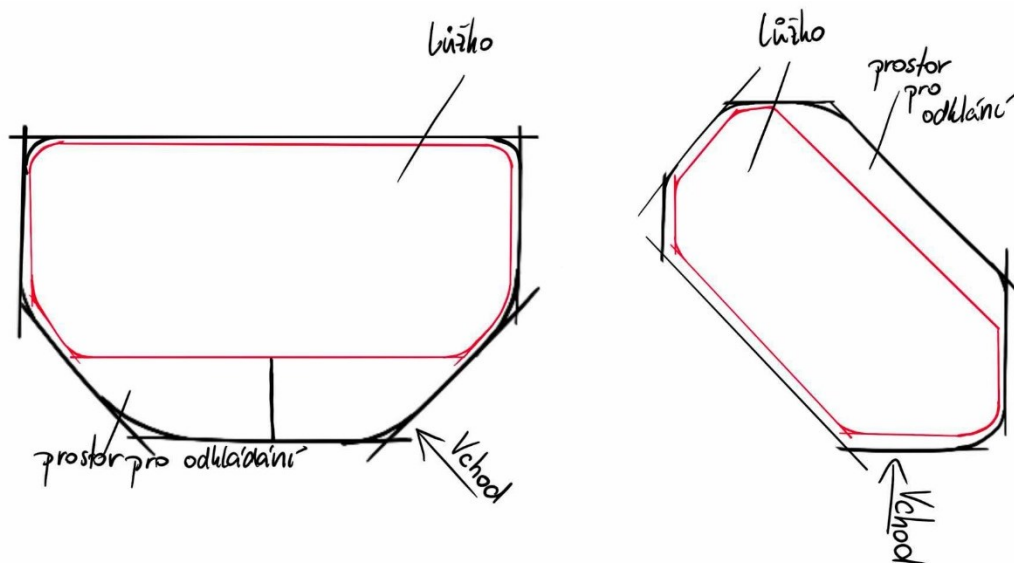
Základní tvarová orientace půdorysů. Zdroj: Archiv autora.
